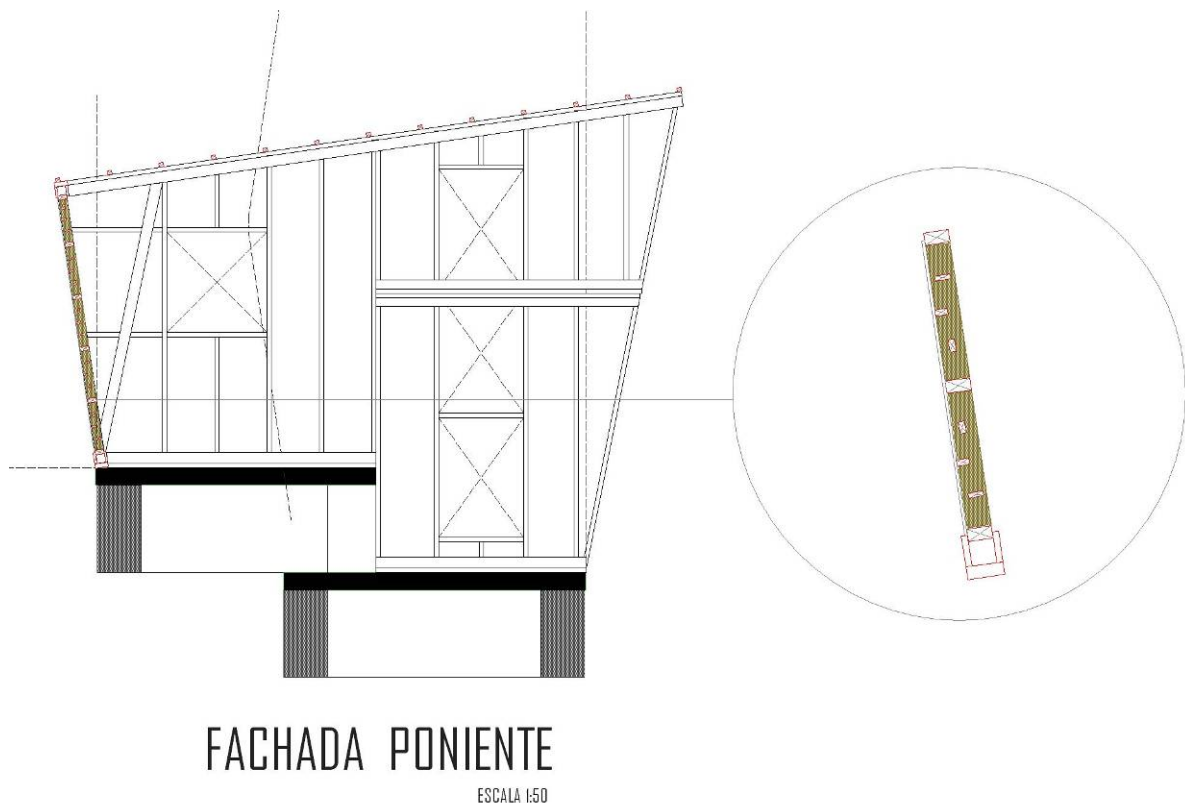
Esquema de la disposición de la estructura de los muros plata baja, con detalle de relleno
